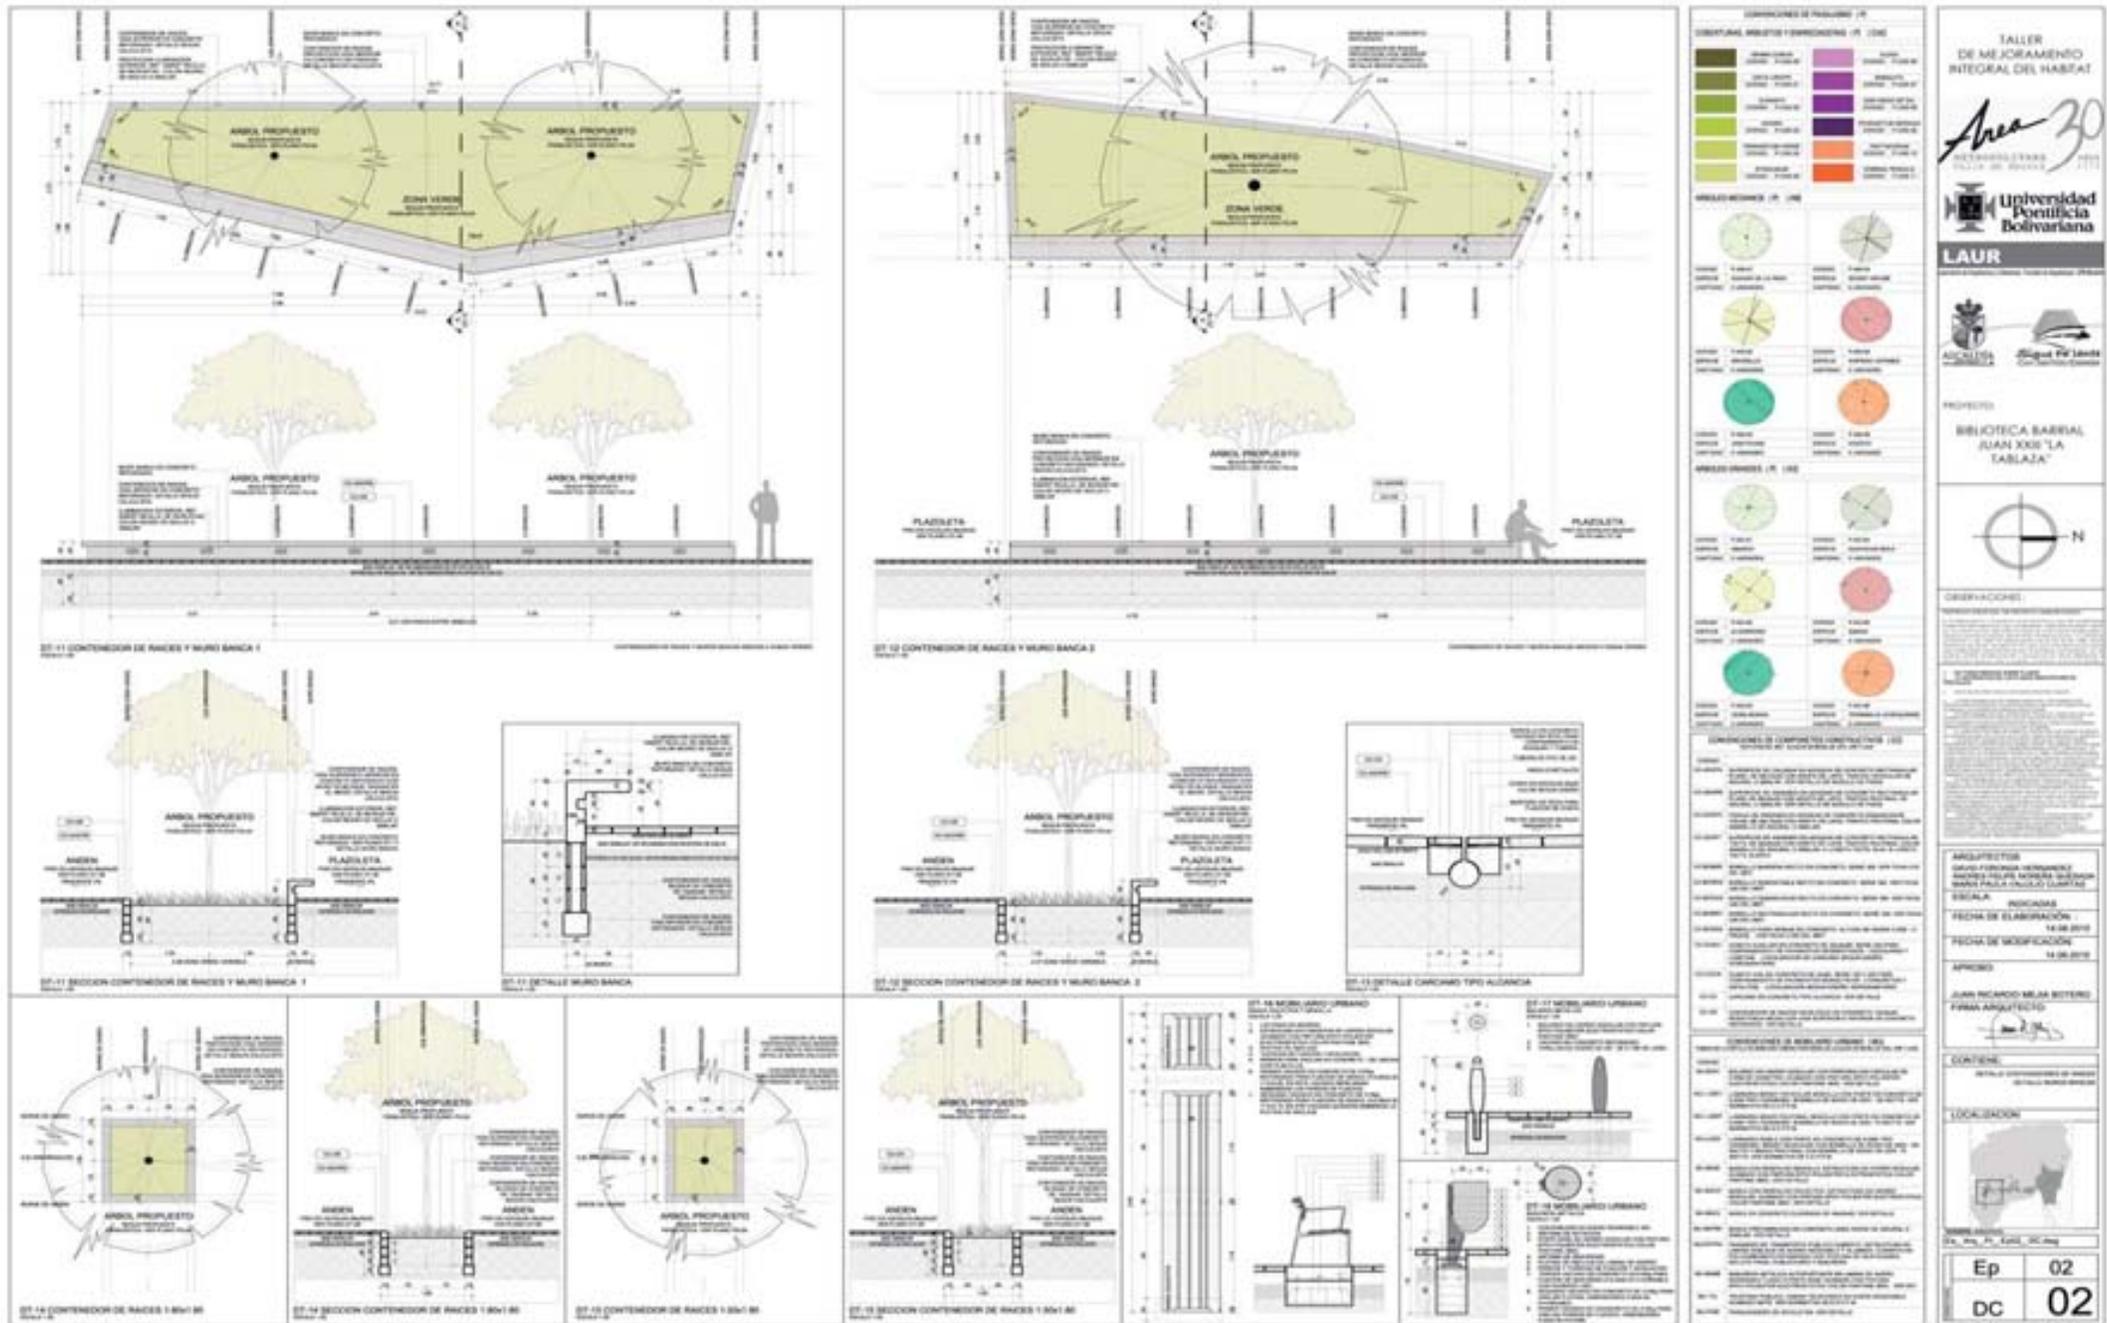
Plantas y secciones con detalles del espacio público. Proyecto biblioteca barrial y centro de capacitación Tulio Ospina (Juan XXIII)
